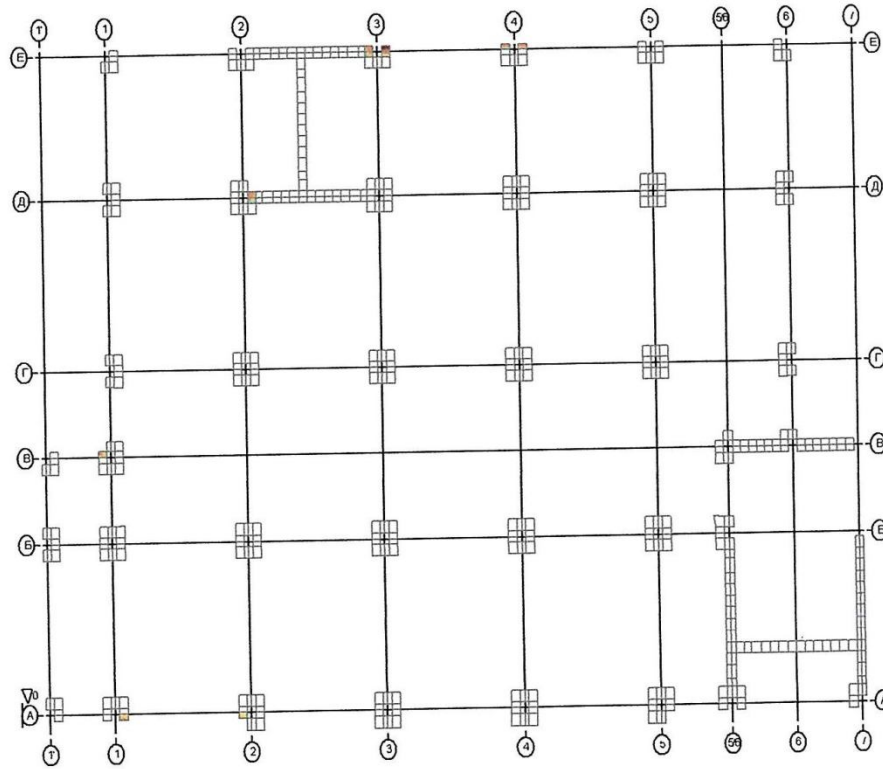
Поперечна арматура у напрямку вісі X (ASW1) у капітелях і ригелях
